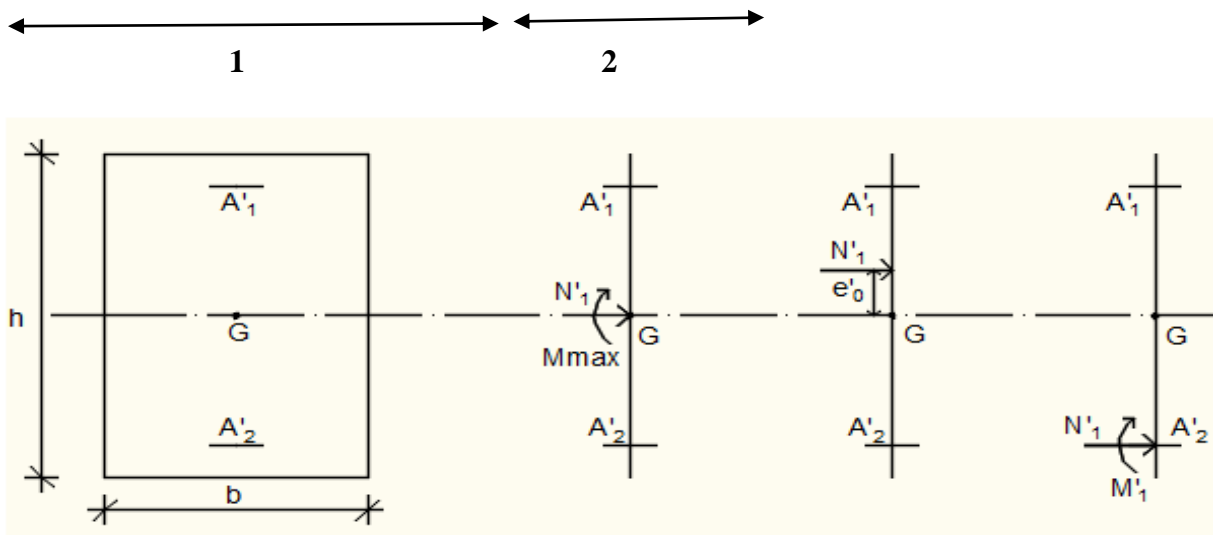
Position de N'_1 , M'_1 et M_1 sur la section transversale.
